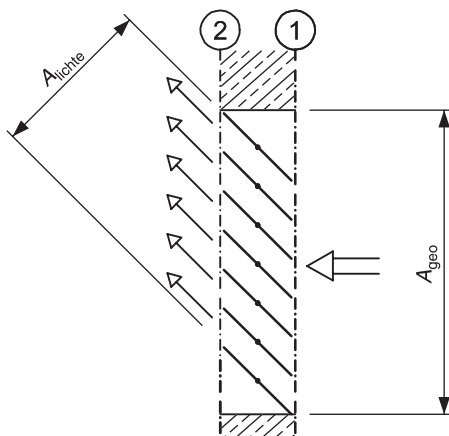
Lamellenartiges Zuluftelement z. B. für Glasfassaden
